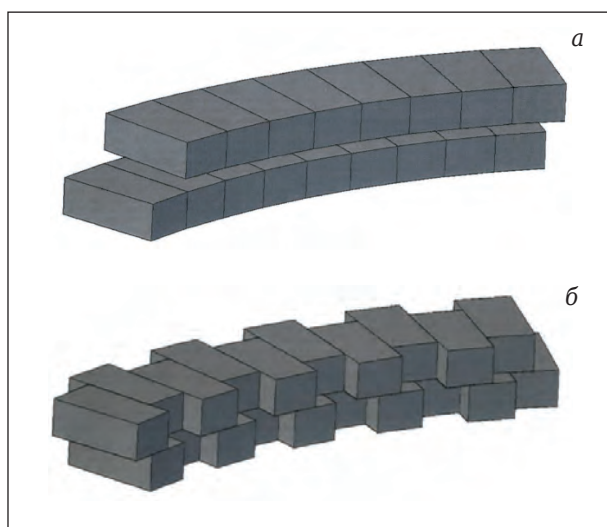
Конструкция стыка футеровки конвертера с отъемным днищем в формате 3D: а — вариант 1; б — вариант 2
